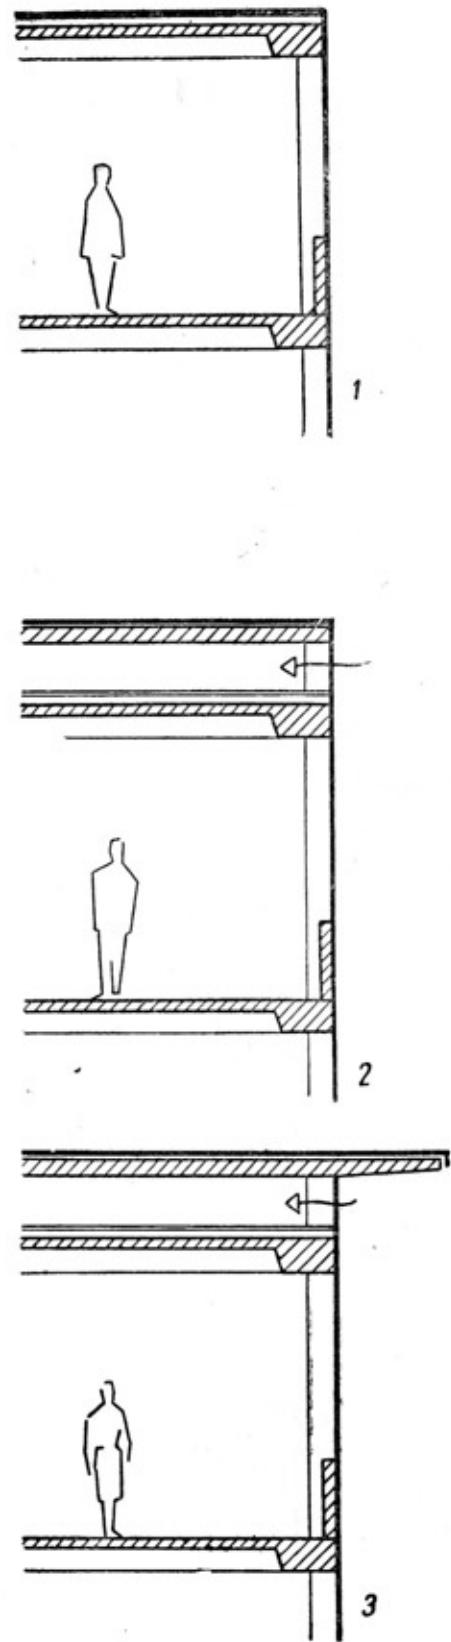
Конструкция и функциональное назначение плоской кровли каркасной конструкции
